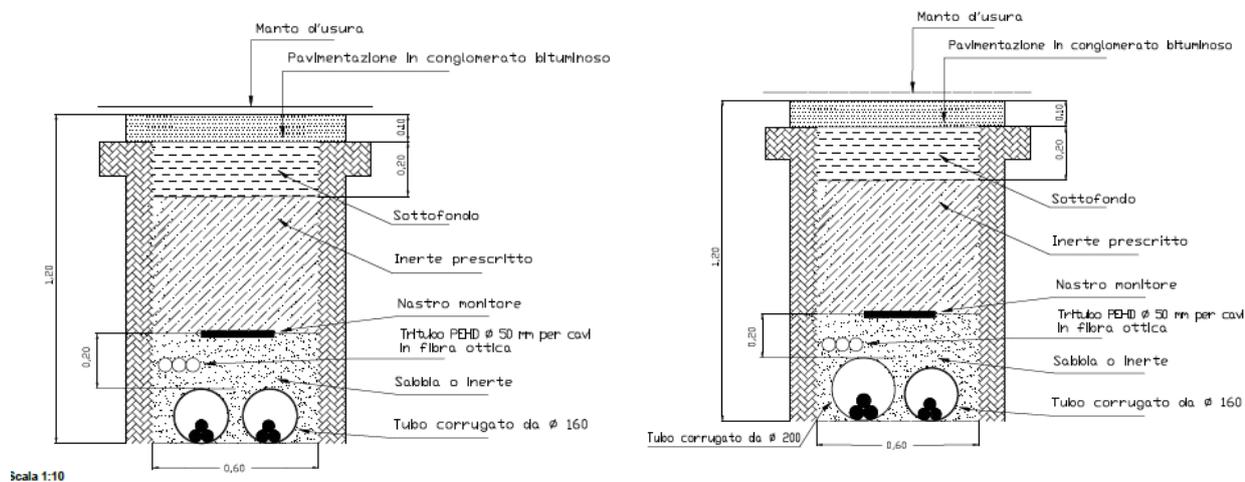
Sezione su strada asfaltata - posa di n°2 cavi MT
